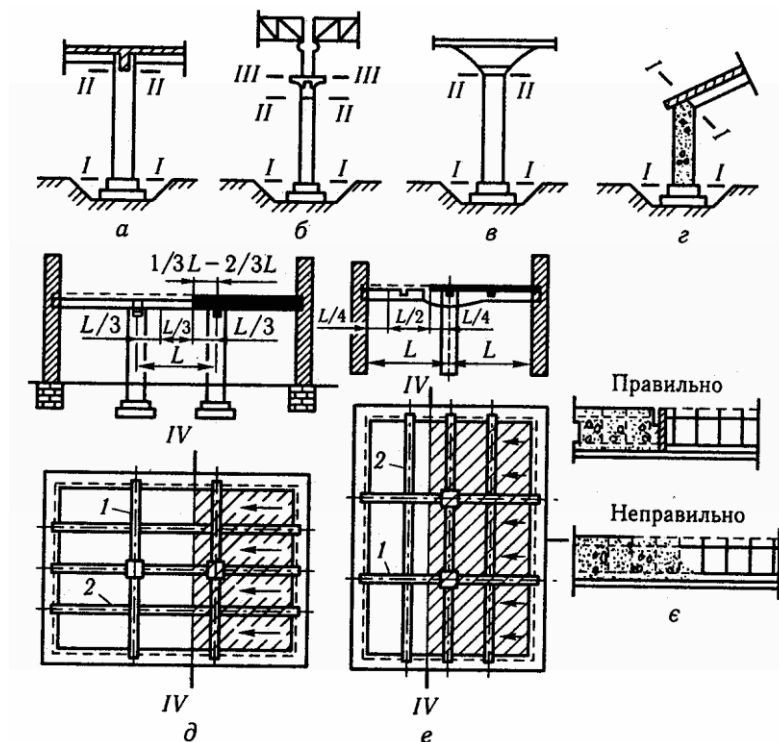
Розміщення робочих швів у процесі бетонування: а – колон і балок ребристого перекриття; б – колон з підкрановими балками; в – колон з
